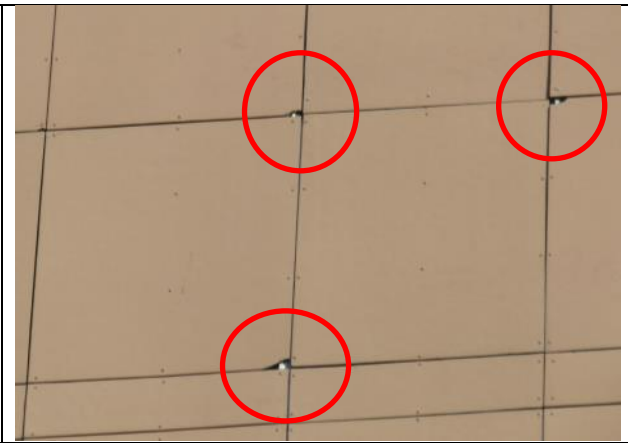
Сколы с выпадением частей плит из облицовки левого торцевого фасада
